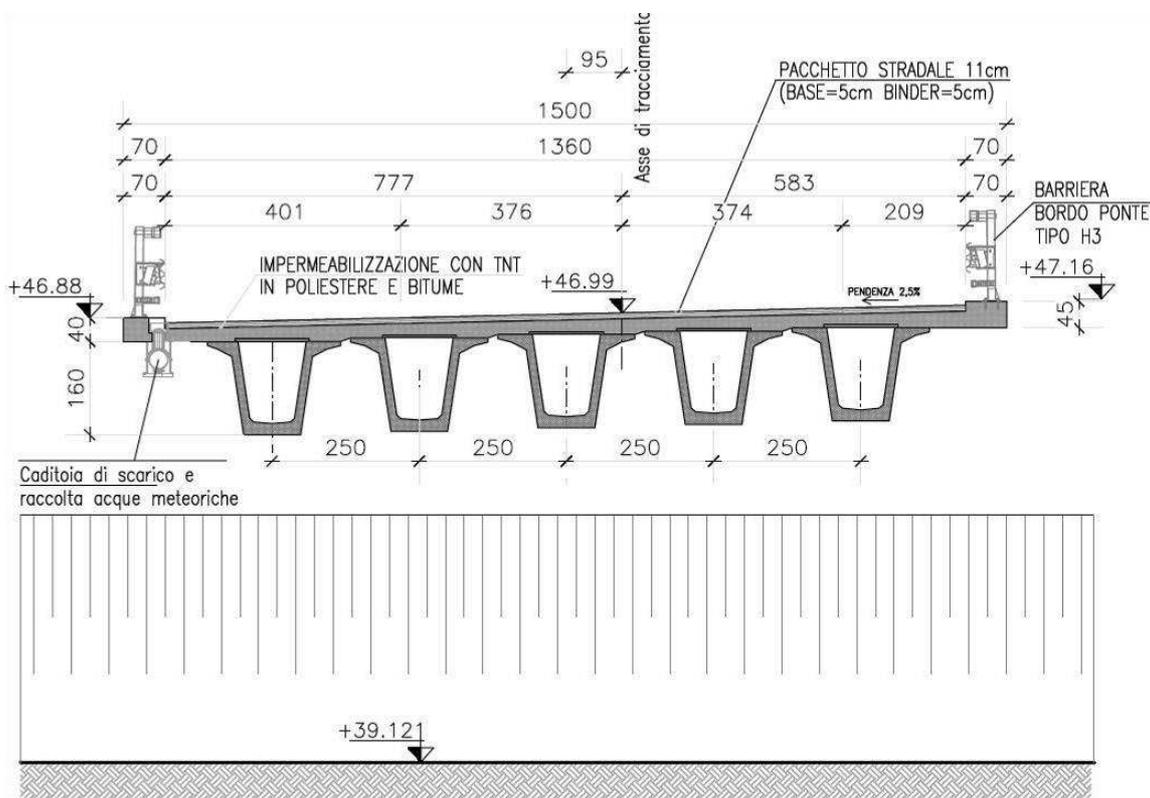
SEZIONE TIPO CAMPATA IN C.A.P. VIADOTTO TORRENTE QUARESIMO
